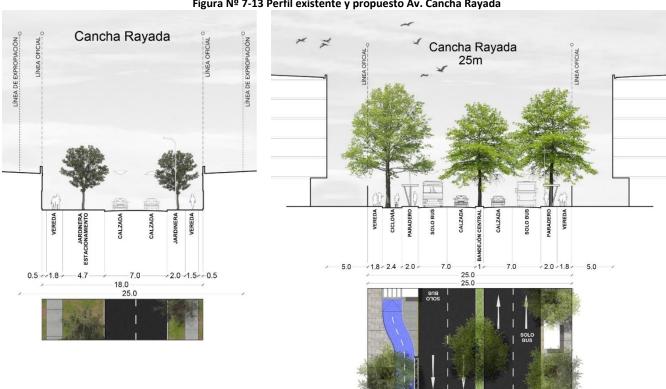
Perfil existente y propuesto Av. Cancha Rayada
